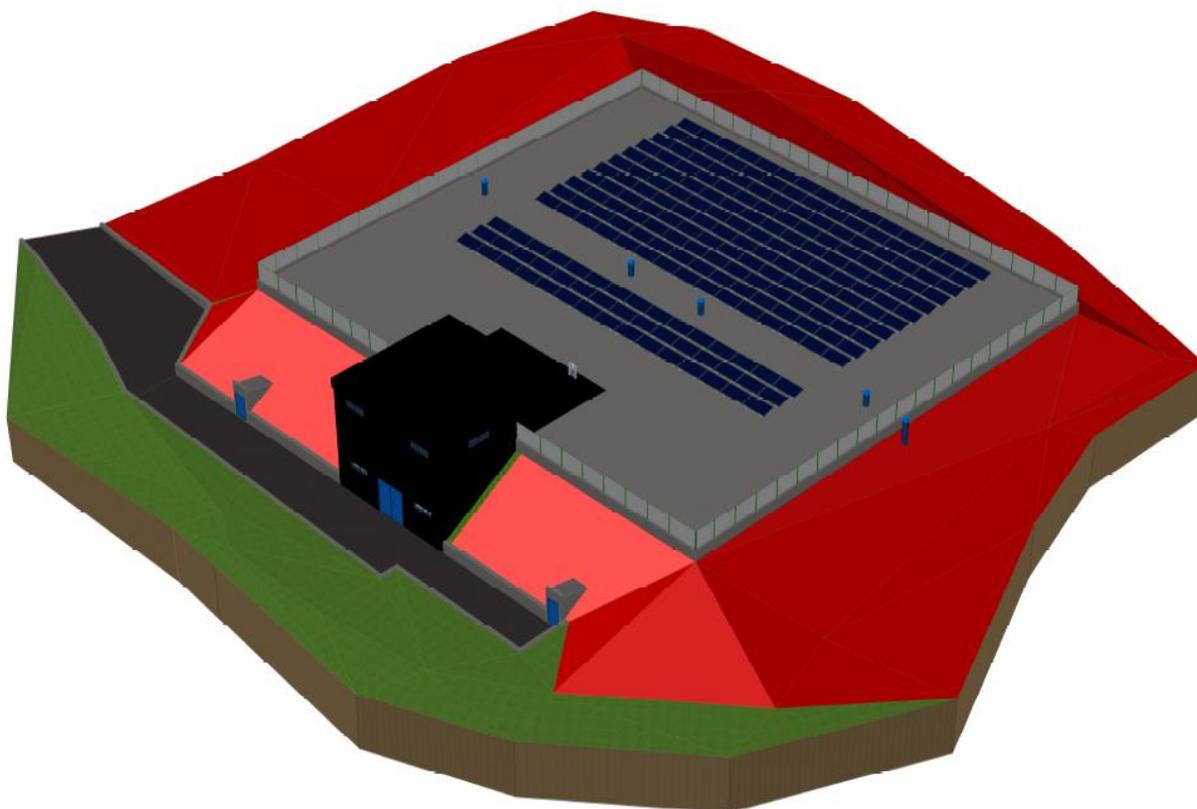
Planimetria 3D dell'intervento con aree da rinverdire (in rosso)
